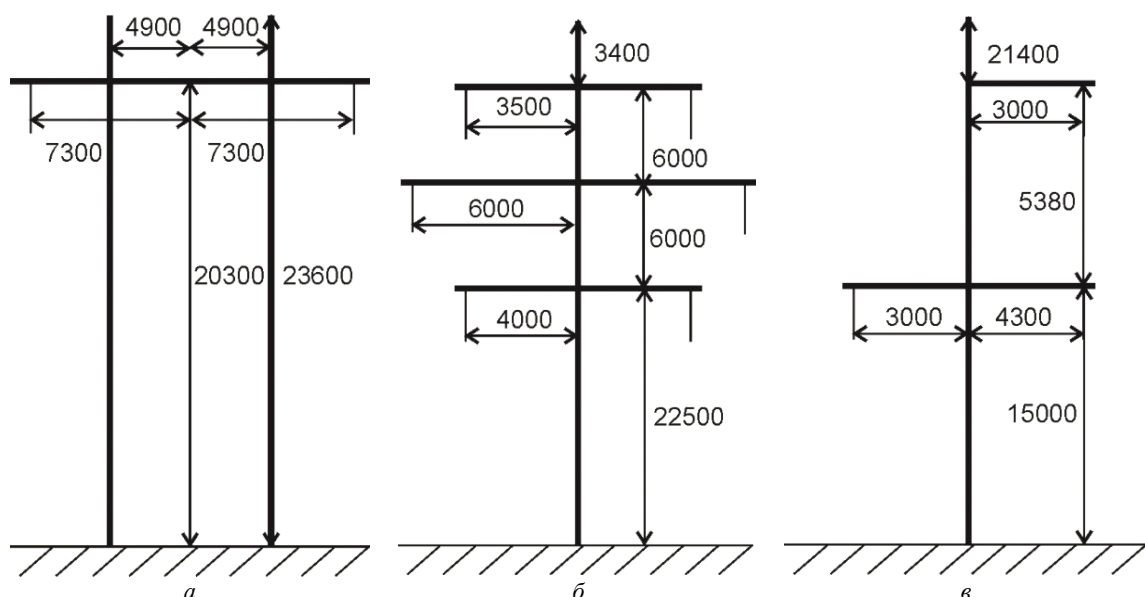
Типові конструкції опор ПЛ 220 кВ з габаритними розмірами (мм)
